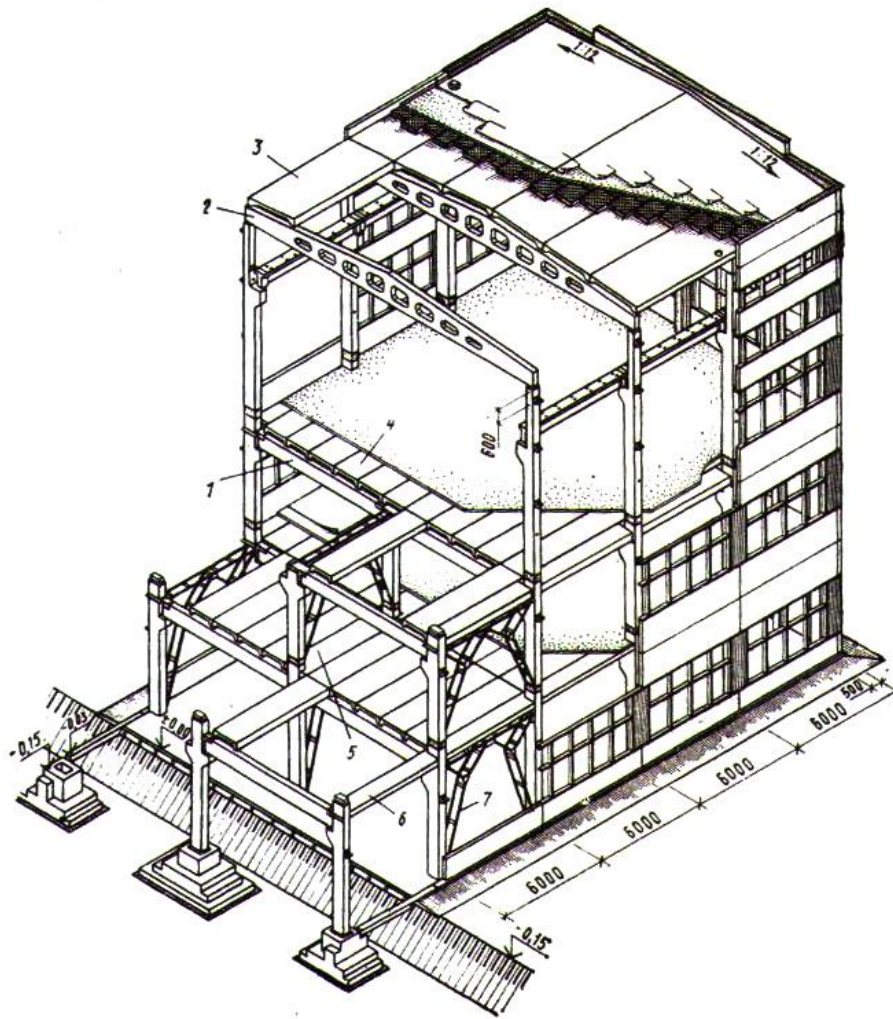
Многоэтажное производственное здание с балочным каркасом из сборных железобетонных конструкций:
